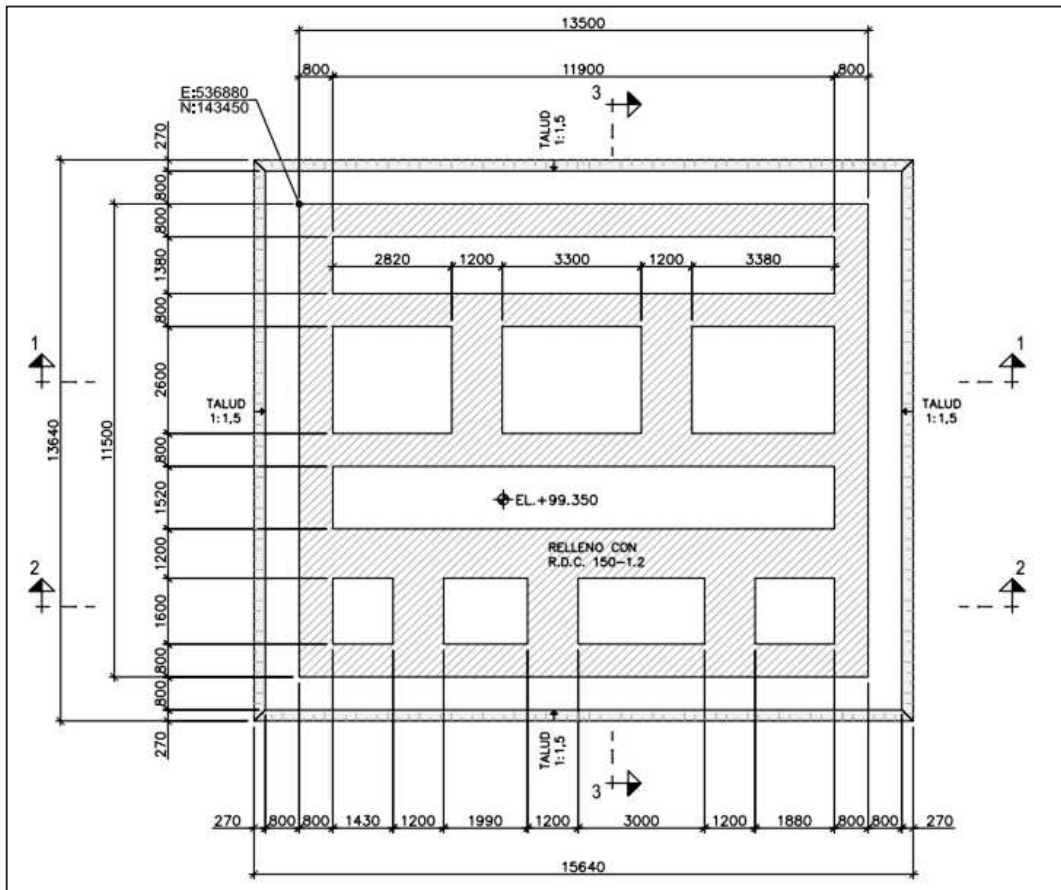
Esquema en planta de distribución de zonas a tratar bajo las fundaciones.
